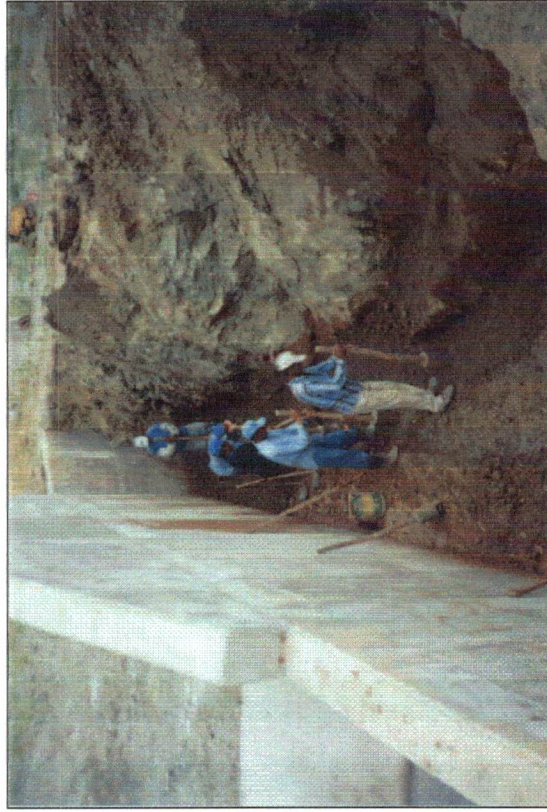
Compactação das primeiras camadas do reatorro, junto ao muro de contenção.
